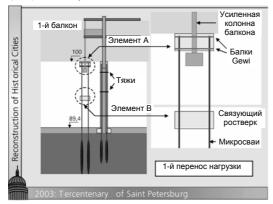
Методы укрепления фундаментов: первая схема перераспределения нагрузки
